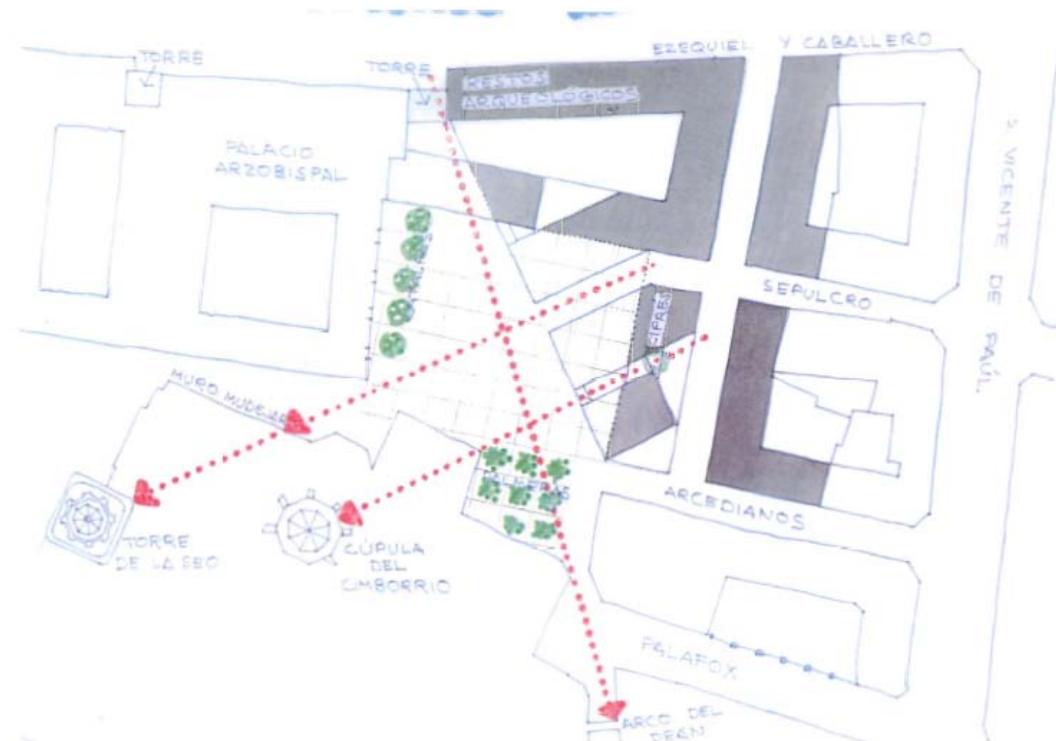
Plano del pavimento de la plaza de San Bruno.
